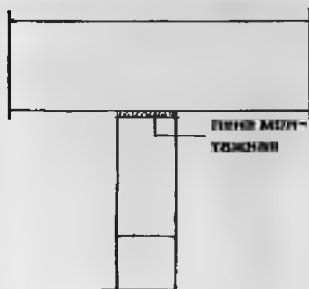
Место примыкания перекрытия заполняют монтажной пеной, благодаря чему стена приобретает дополнительную устойчивость
